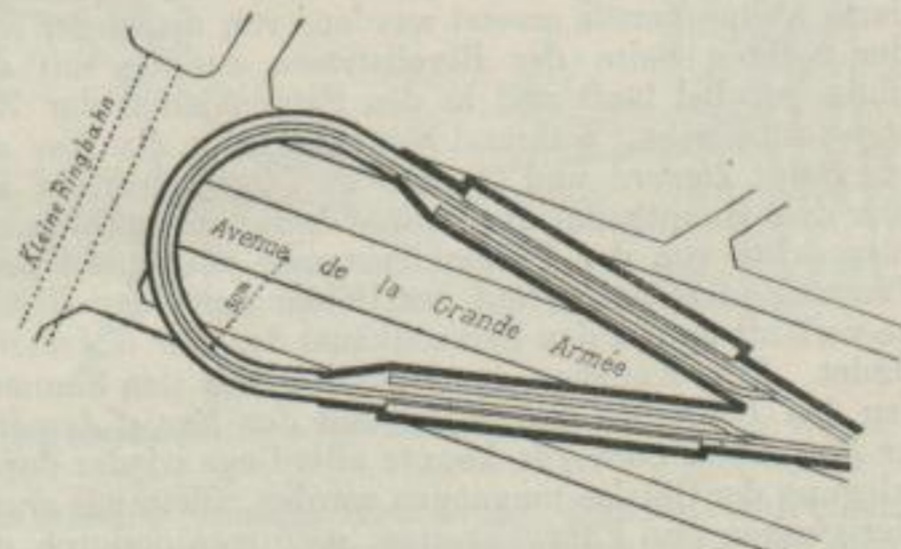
Lageplan der Endstation Porte de Dauphiné.
